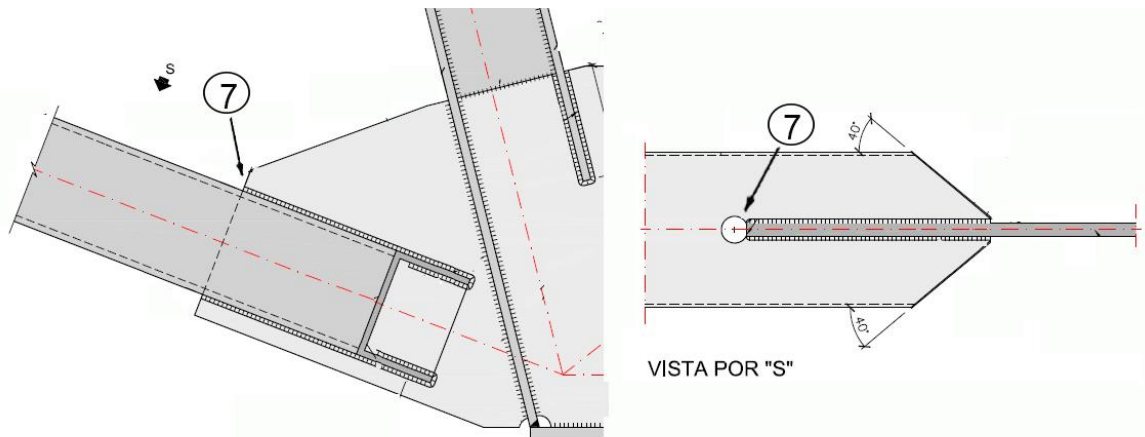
Pormenor de ligação da escora metálica ao caixão e pormenor crítico
